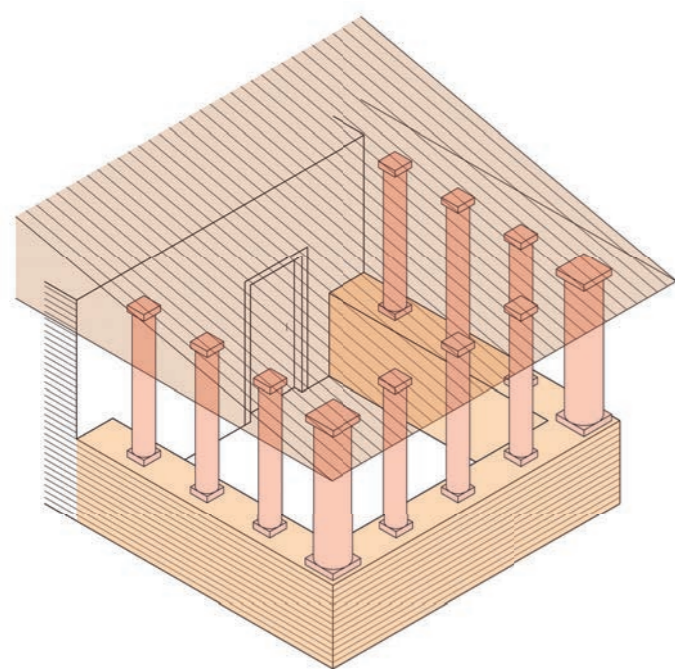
Hipótesis galería intervención Miguel Altué. De abajo a arriba: murete de ladrillo, columnas de piedra y alero de madera.
